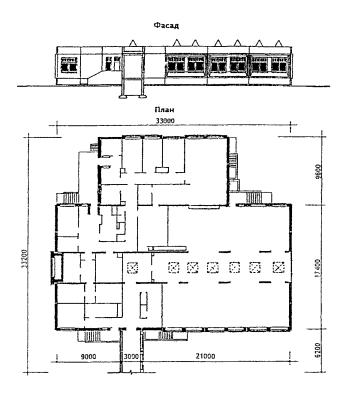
Проект блока-пристройки столовой на 300 посадочных мест И-1783/2 (разработан в 1999 году). Фасад и план 1 этажа.
